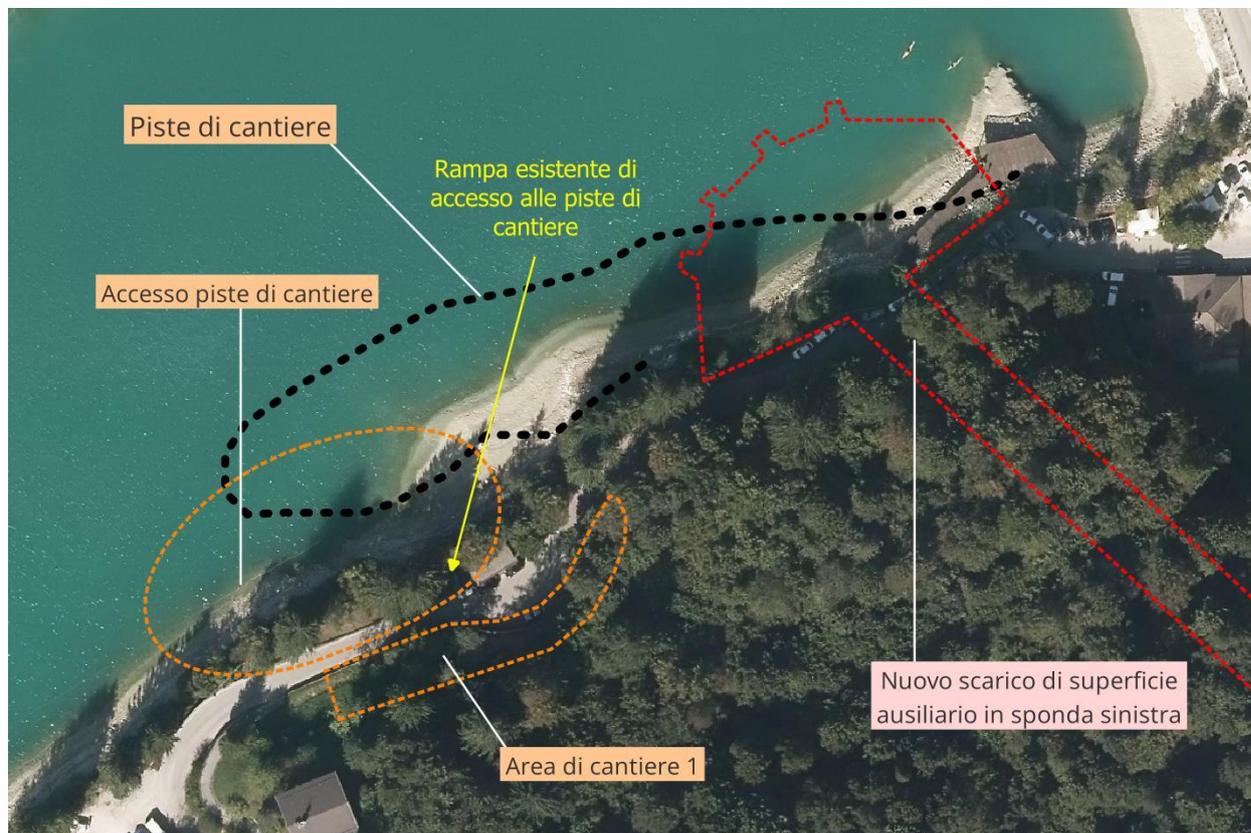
Localizzazione su ortofoto dell'area di cantiere 1 e dell'accesso alle piste di cantiere.
